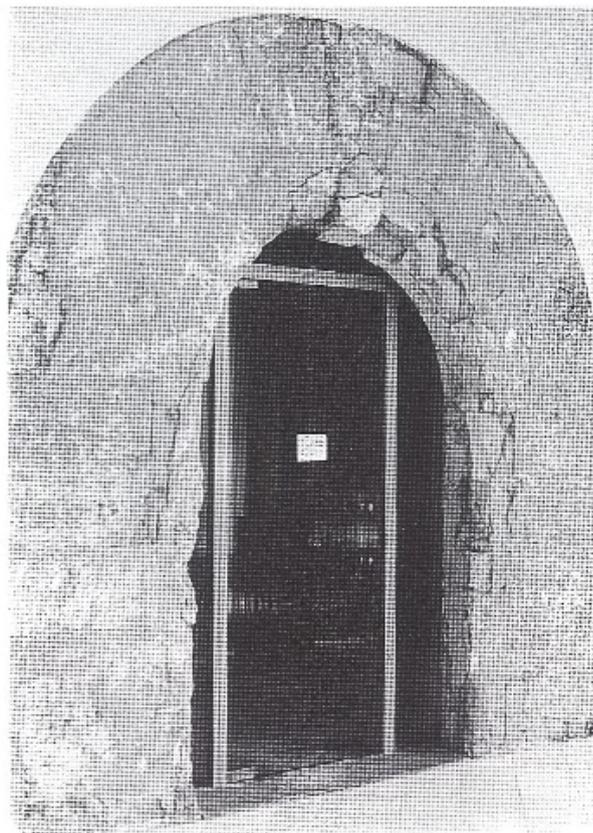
Septiembre de 1992. Estado actual de la antigua puerta de acceso a la primera planta desde la escalera que hubo en el patio, que fue descubierta en 1984 durante la primera fase de la rehabilitación. La piedra está calcinada por efecto del incendio que sufrió el edificio en la Guerra de Sucesión de 1707. Fue enlucida y convertida en balcón de vano adintelado.
